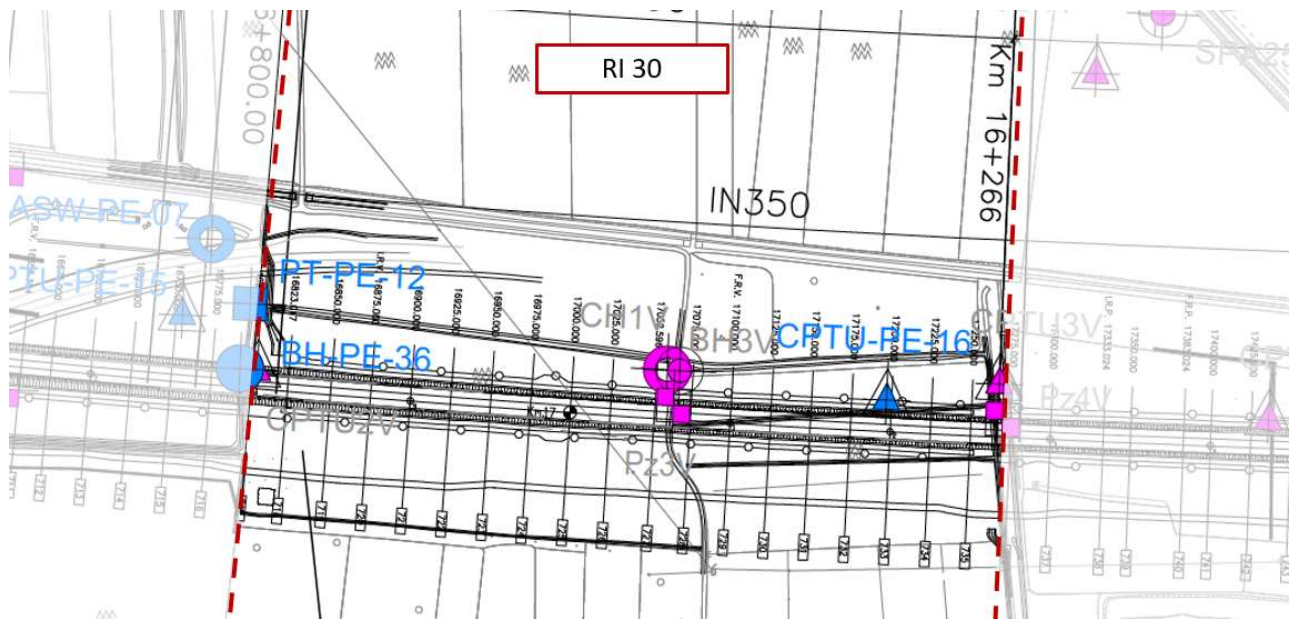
Planimetria Rilevato RI30, estratto dalla Planimetria Generale (Doc. Rif. [3])
